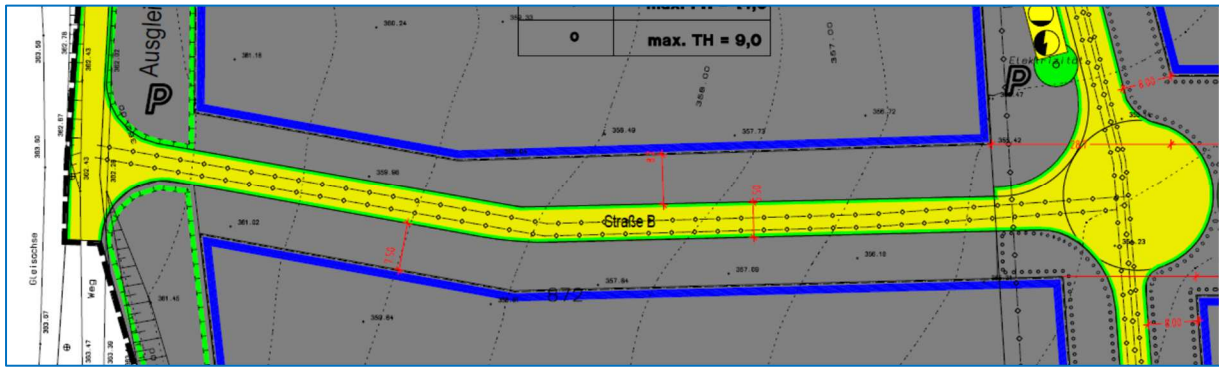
Ausschnitt B-Plan - Ursprungsplanung - geplante Lage der Erschließungsstraße
